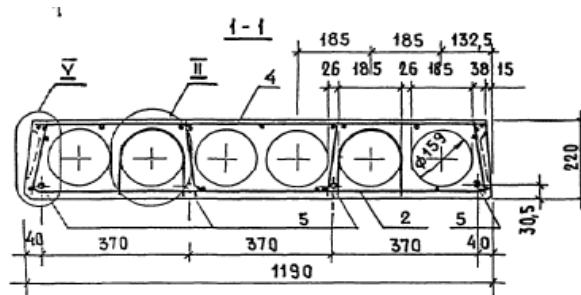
Поперечное сечение плиты перекрытия с основными геометрическими размерами
